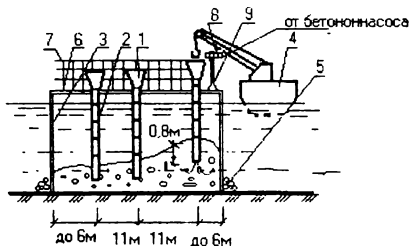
Подводное бетонирование методом вертикально перемещающихся труб (ВПТ).
